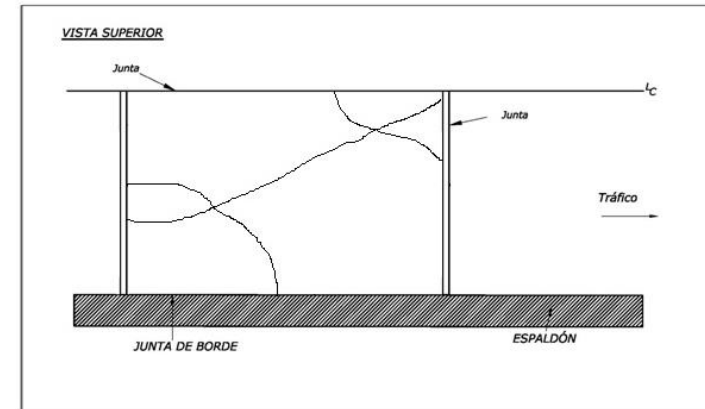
Esquema Losa Dividida- Pavimento Rígido
